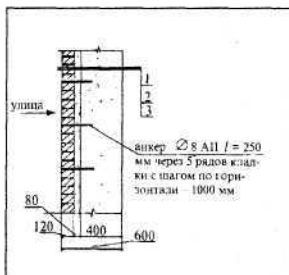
Стена из пенобетонных блоков (для жилых помещений):
